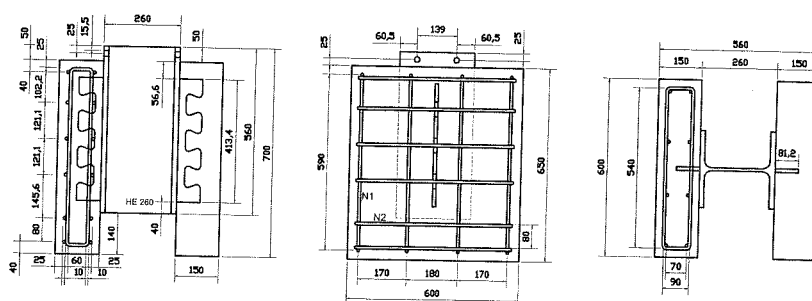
Configuração de um modelo com conector CR56b com armadura passante
